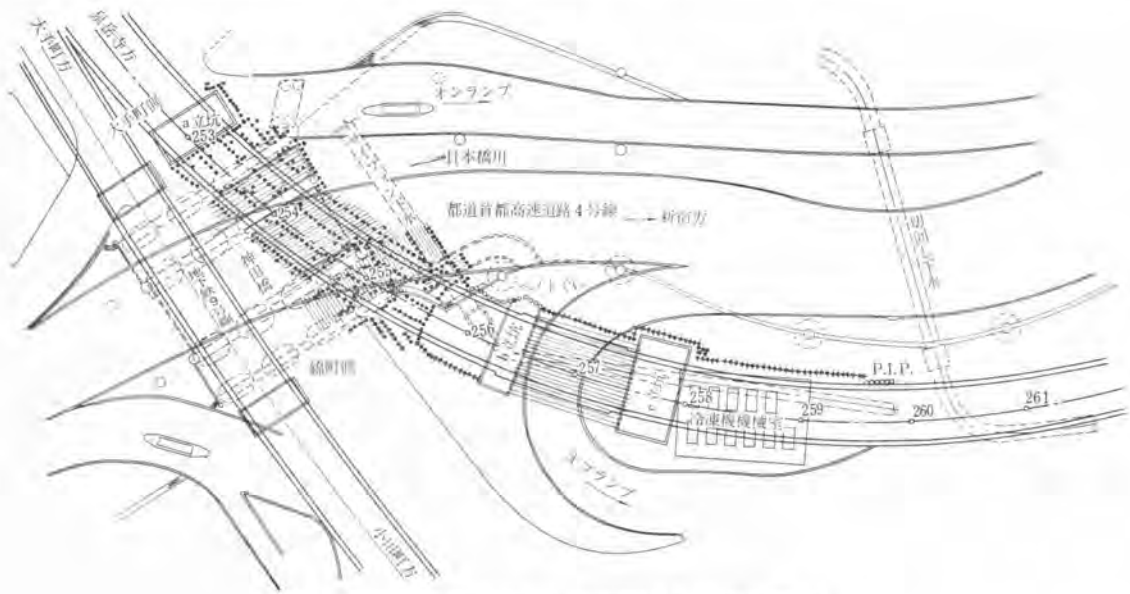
地下鉄神田橋工区平面図(鉛直凍結管および測温管配置)
